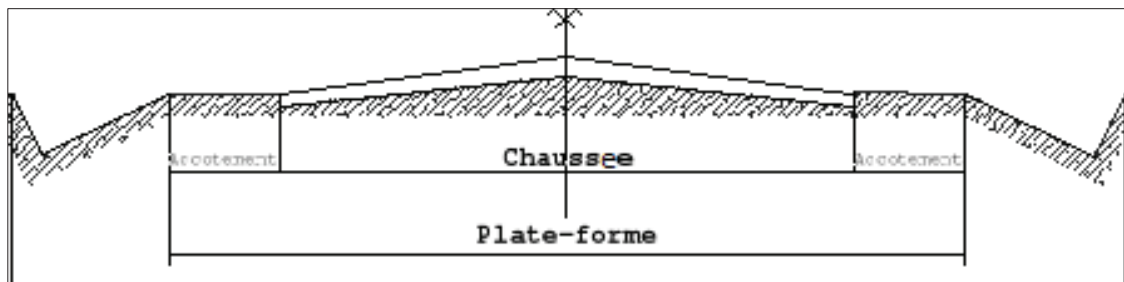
PROFIL EN TRAVERS EN TOIT
